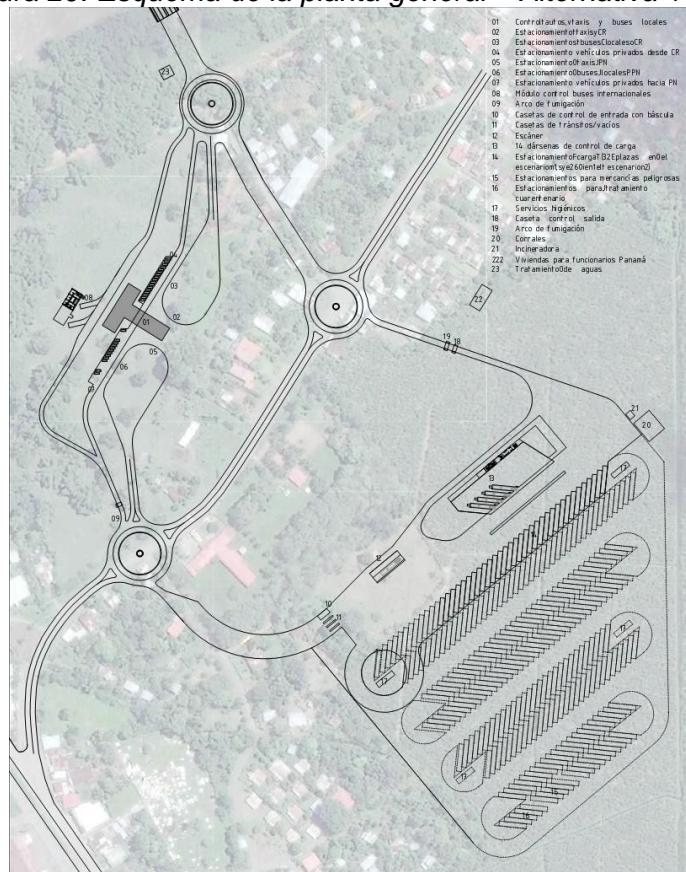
Esquema de la planta general – Alternativa 1 (CR)
